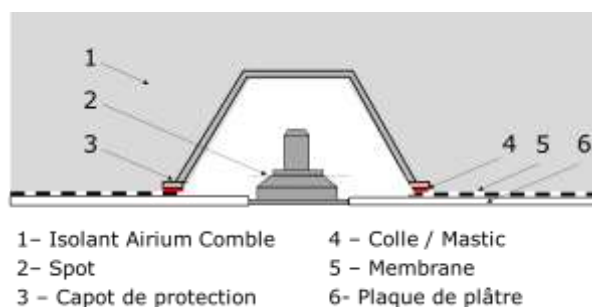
Capot de protection pour spot encastrés sur plafonds suspendus en plaque de plâtre
